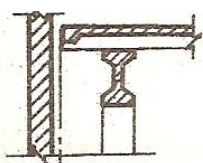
Устройство приторцоввой стойки фахверка
